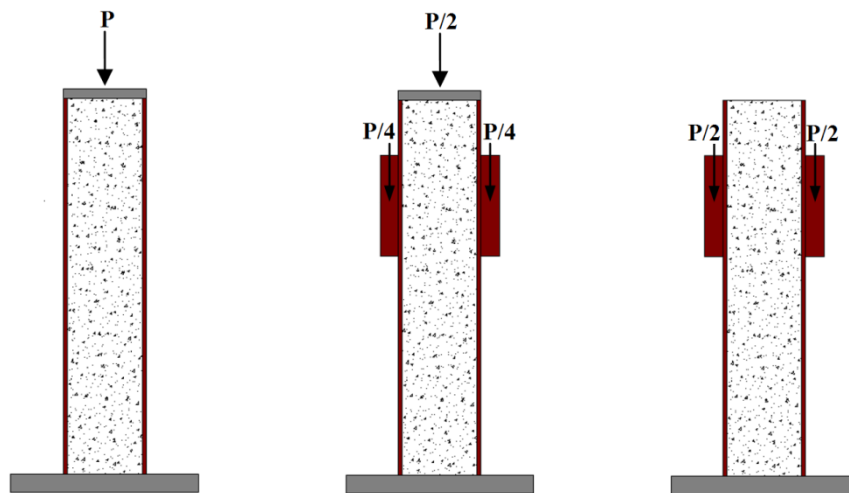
Tipos de ensaios analisados por Dunberry *et al.* (1987) e Mollazadeh e Wang (2015, 2016): (a) ensaios de pilares; (b) ensaios de pilares com chapas de topo e com chapas de ligação; (c) pilares com chapas de ligação.
